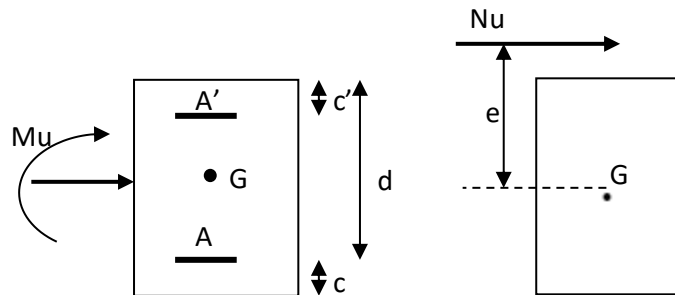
Les moments s'exerçant sur les poteaux
